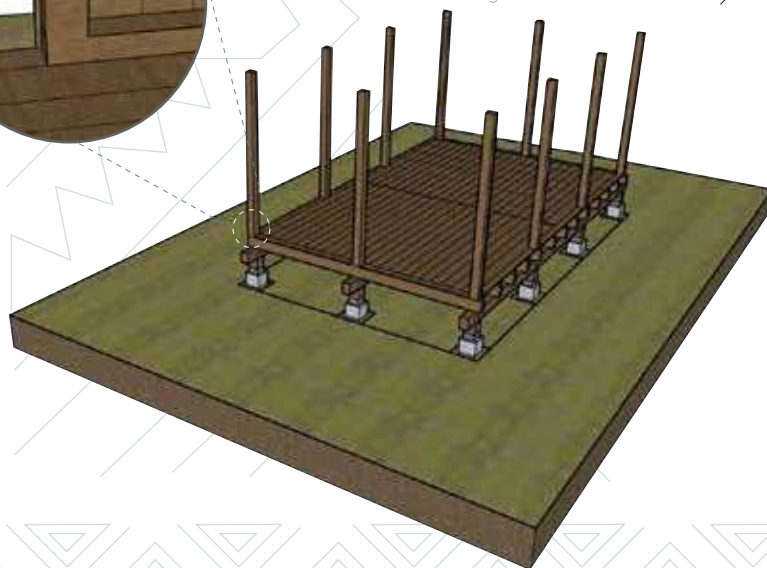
Detalle constructivo unión columna lateral y viga de madera
